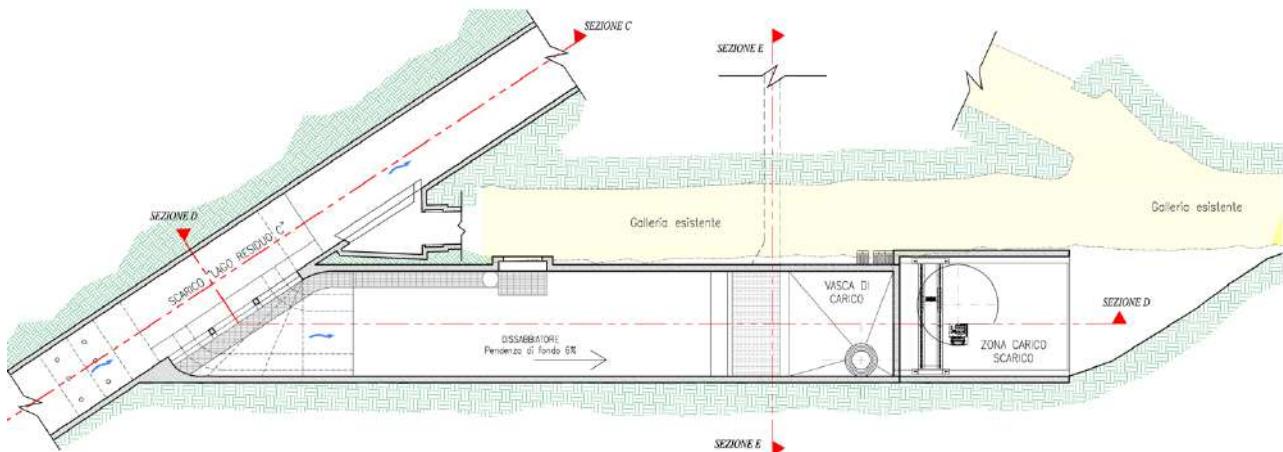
Planimetria particolareggiata dell'opera di presa: in primo piano il tratto terminale della galleria di sorpasso e l'opera di captazione dell'impianto in progetto.
